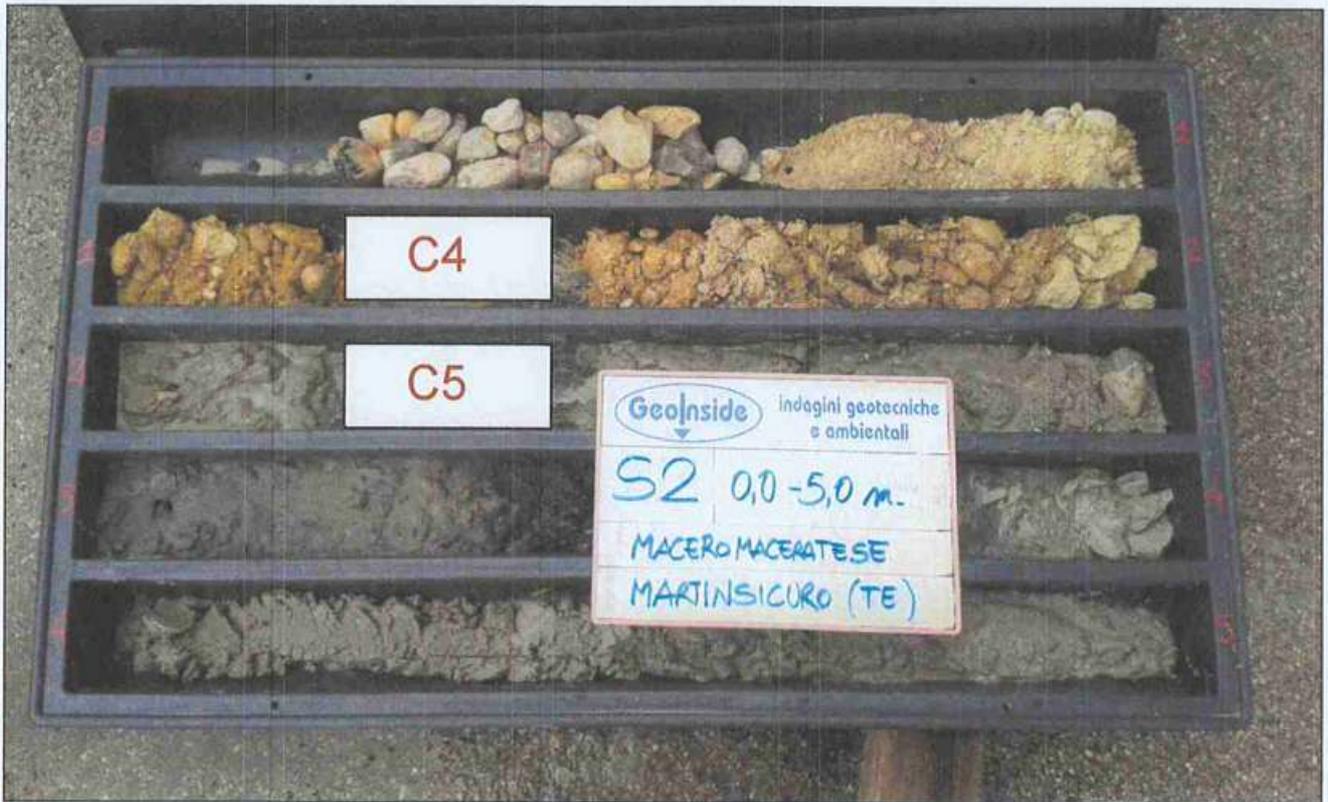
Cassetta del sondaggio S2 da 0,0 a 5,0 m.
